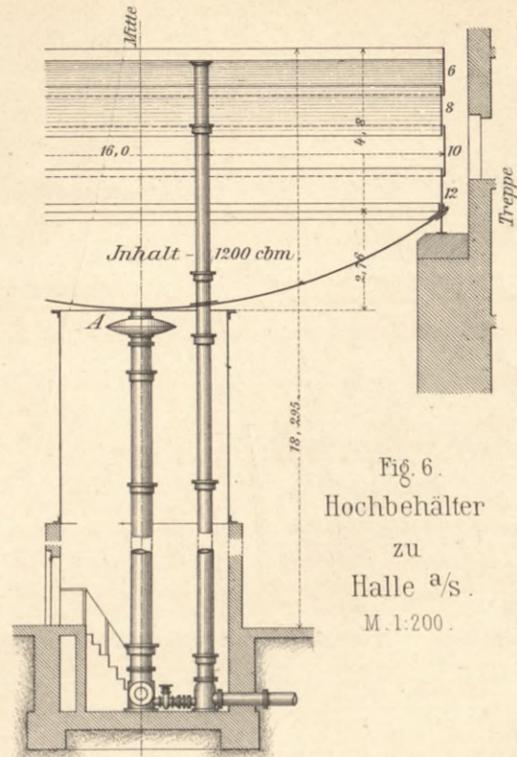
Hochbehälter zu Halle a/s. M. 1:200.
